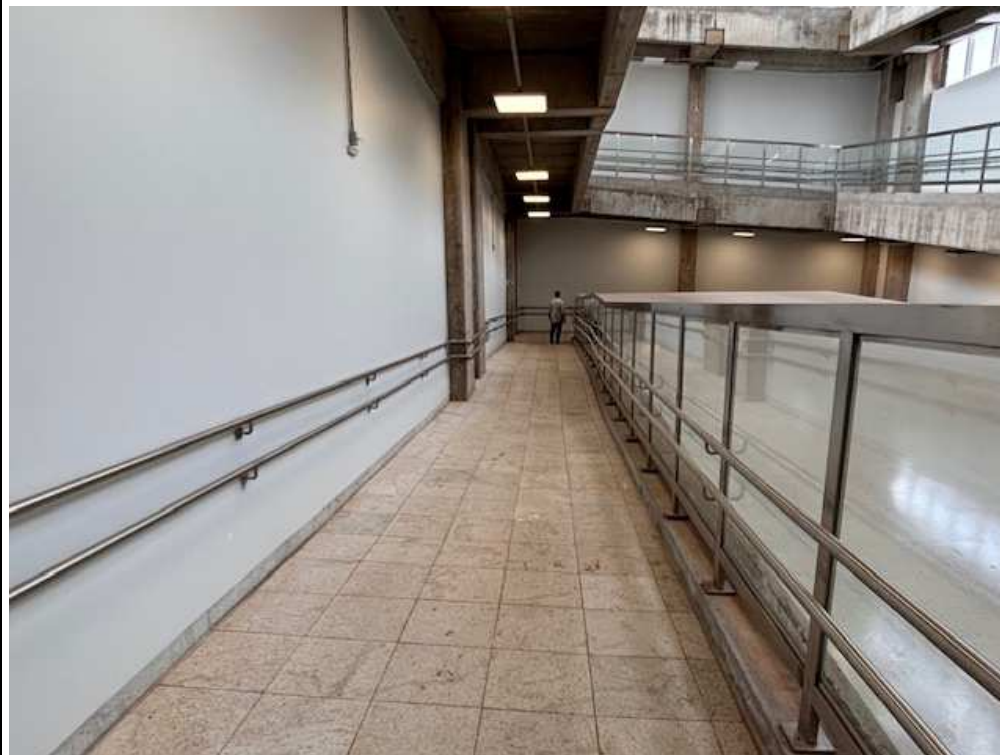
Detalhe da rampa de acesso para acesso e entrega dos equipamentos do térreo ao 1º pavimento. Largura de 2,00 mts.
